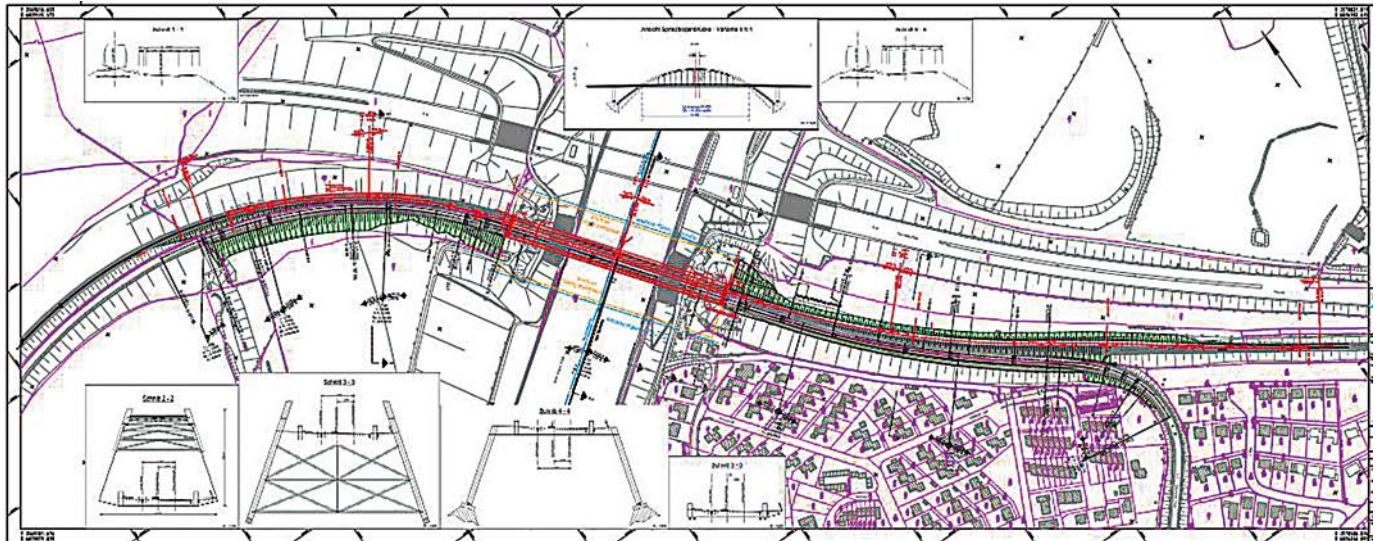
Lageplan – Verkehrsplanung (Planung Dannenberg-EDS)
